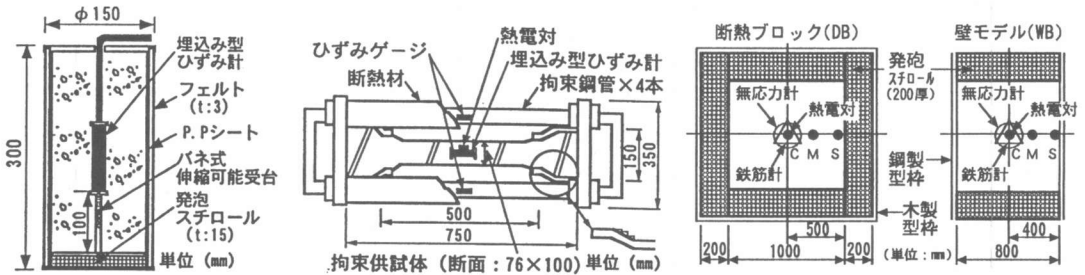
自己収縮(膨張)試験体 図-2 温度ひび割れ試験装置 図-3 各種マスブロック試験体
